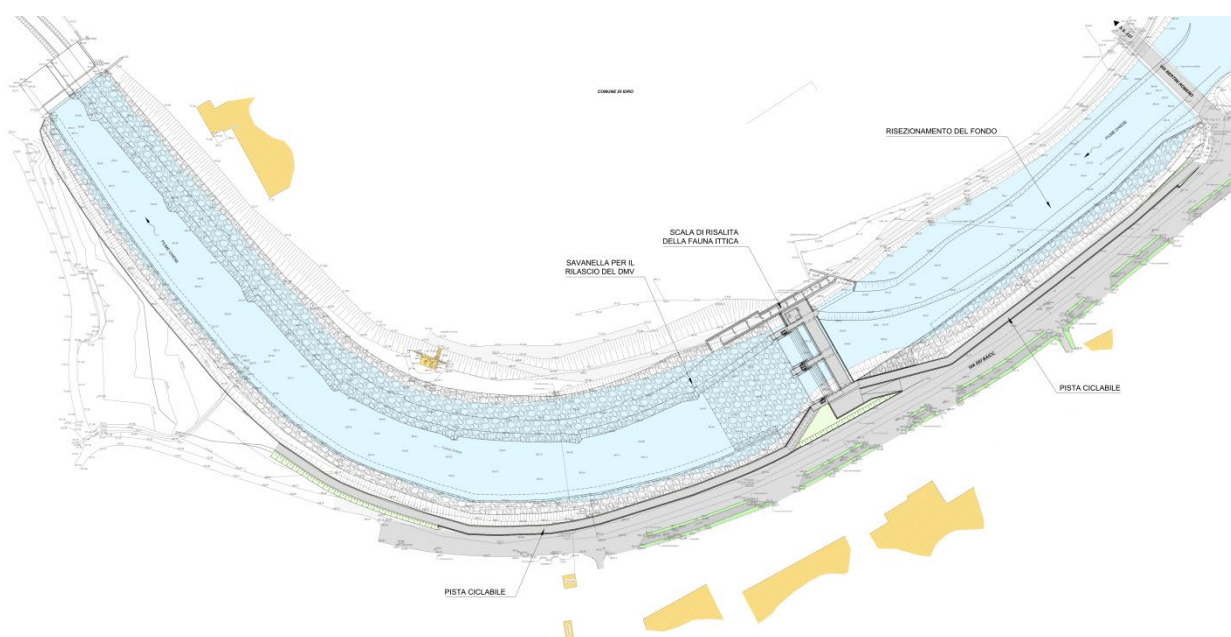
Planimetria nuova traversa e sistemazione alveo Fiume Chiese
